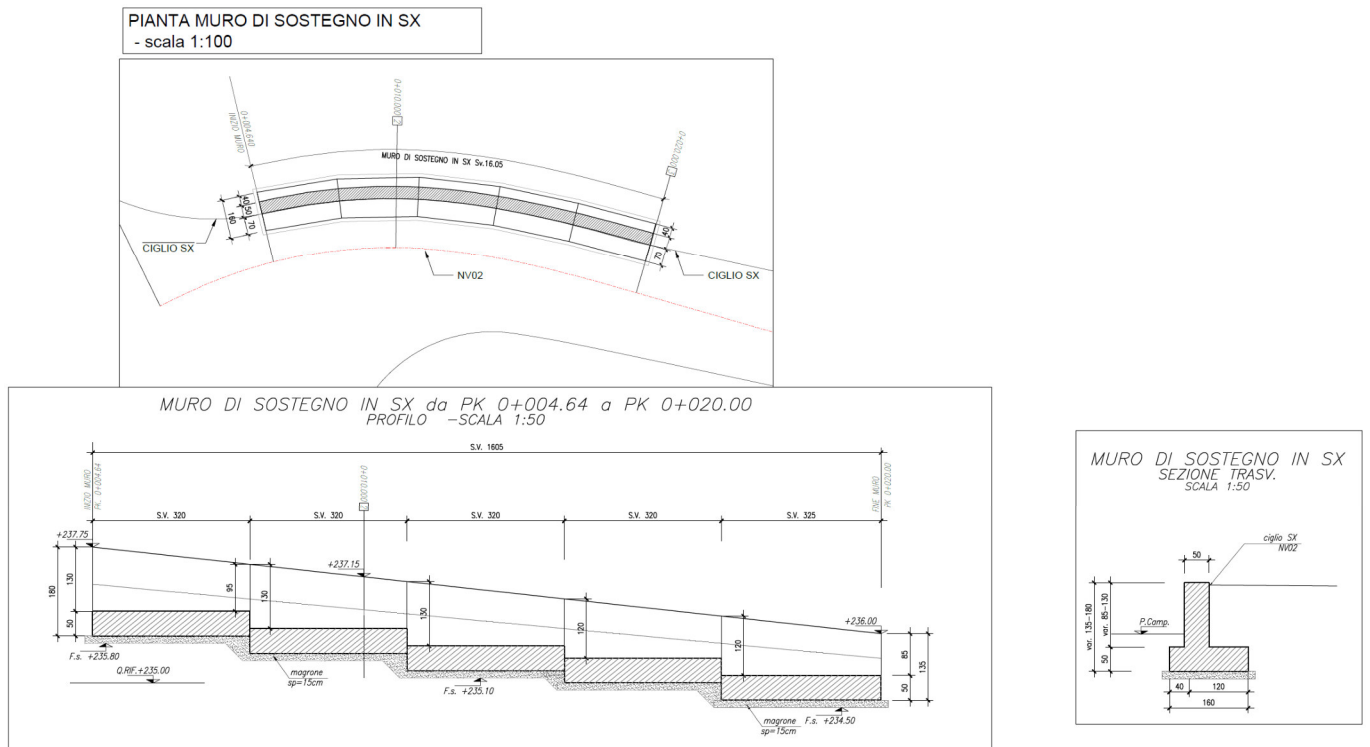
NV02 – Pianta, profilo e carpenteria muro tra la pk 0+004,64 e la pk 0+020
